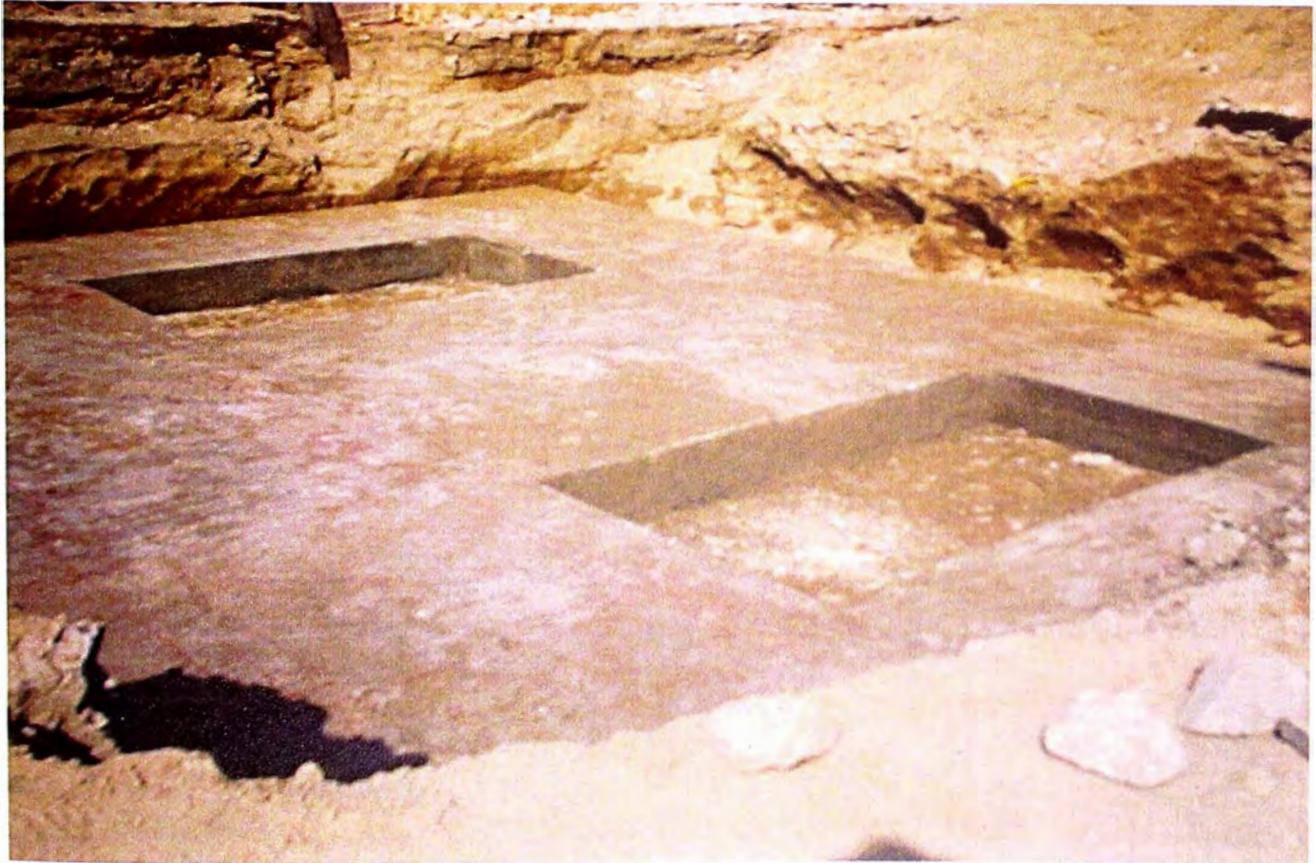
VISTA DE VACEADO DE SOLADO PARA SS.HH.
